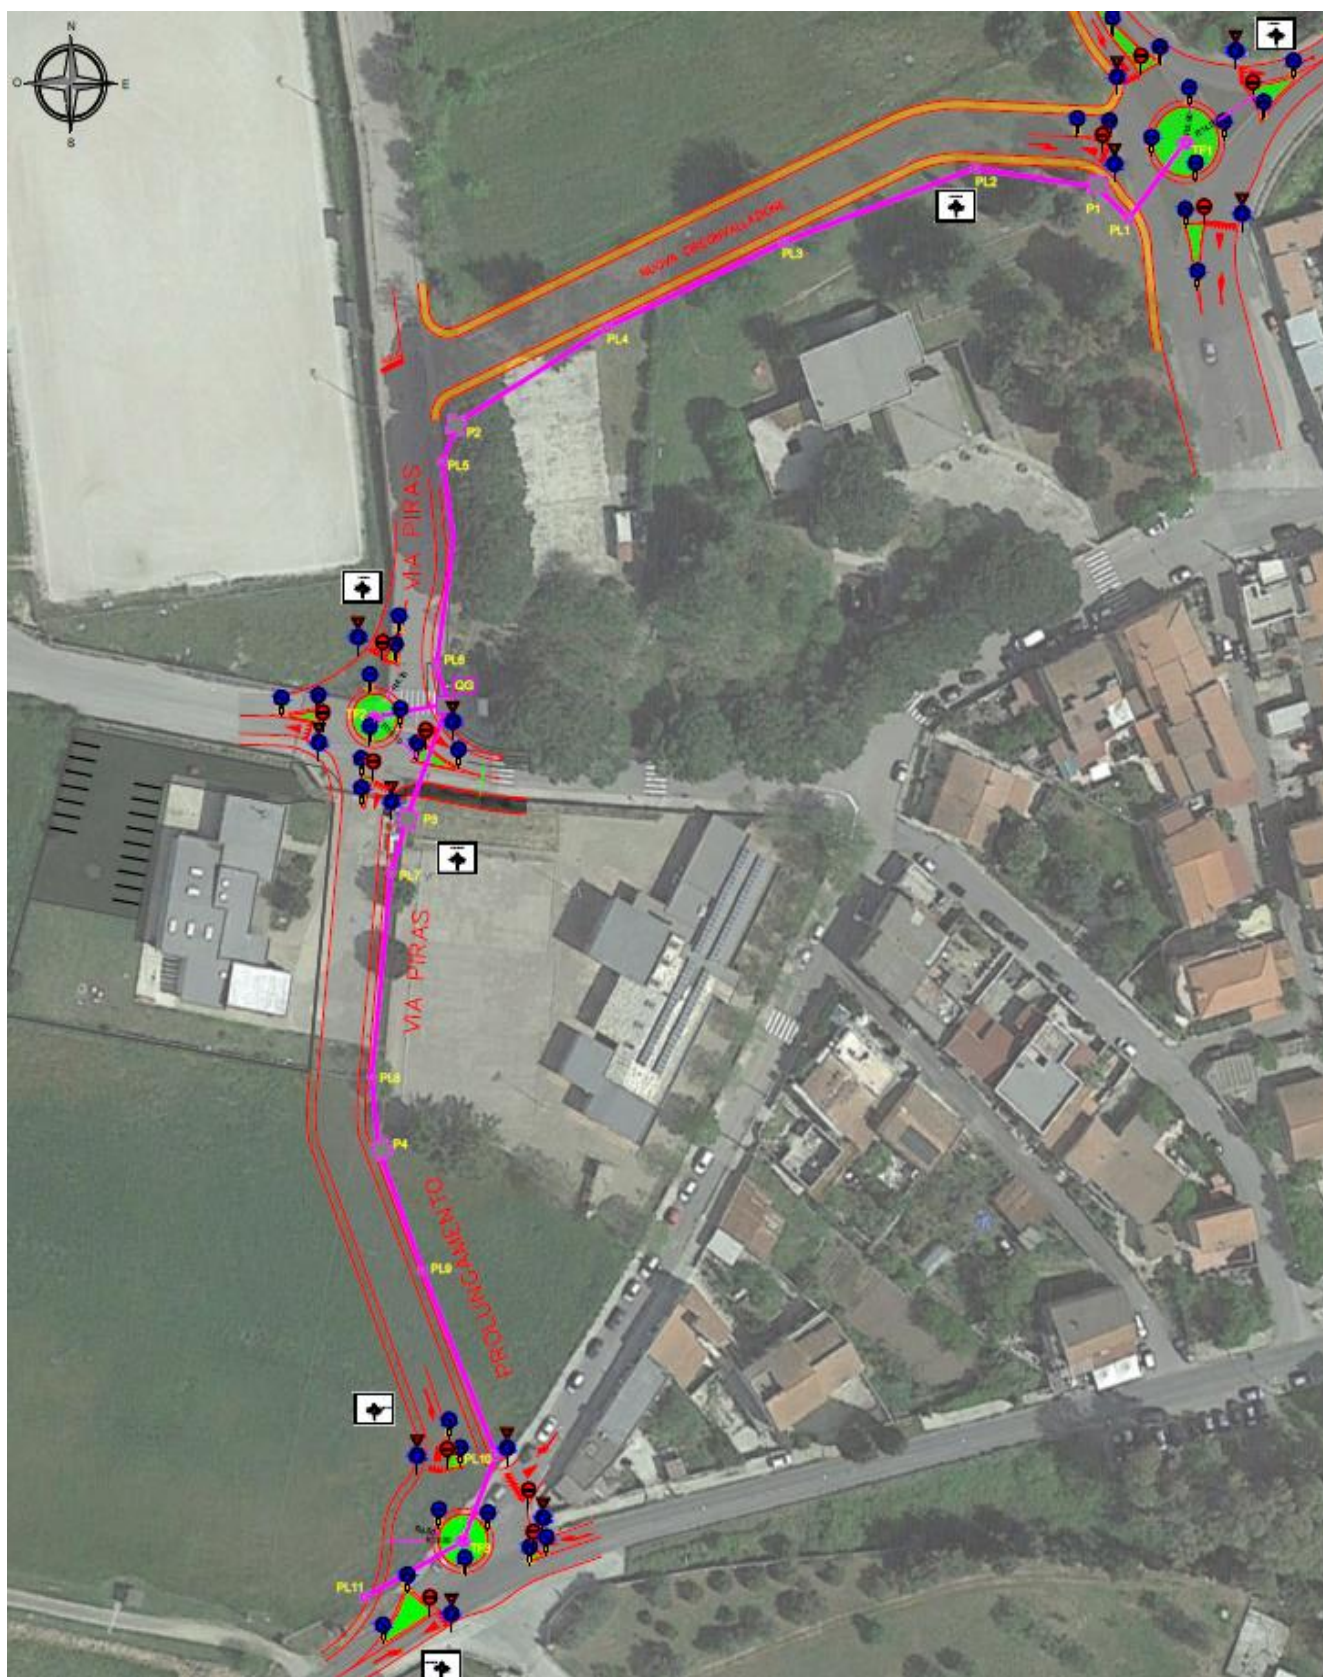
Planimetria interventi - Infrastrutture della viabilità
